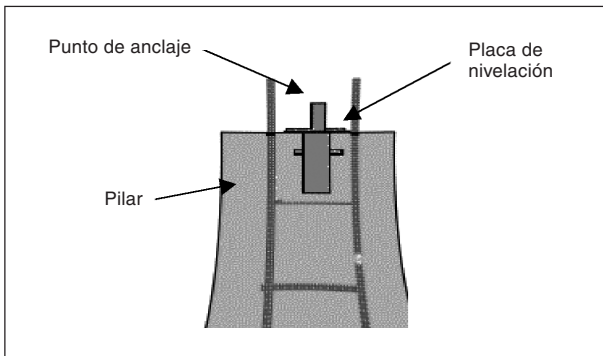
Detalle del punto de anclaje instalado sobre el pilar
